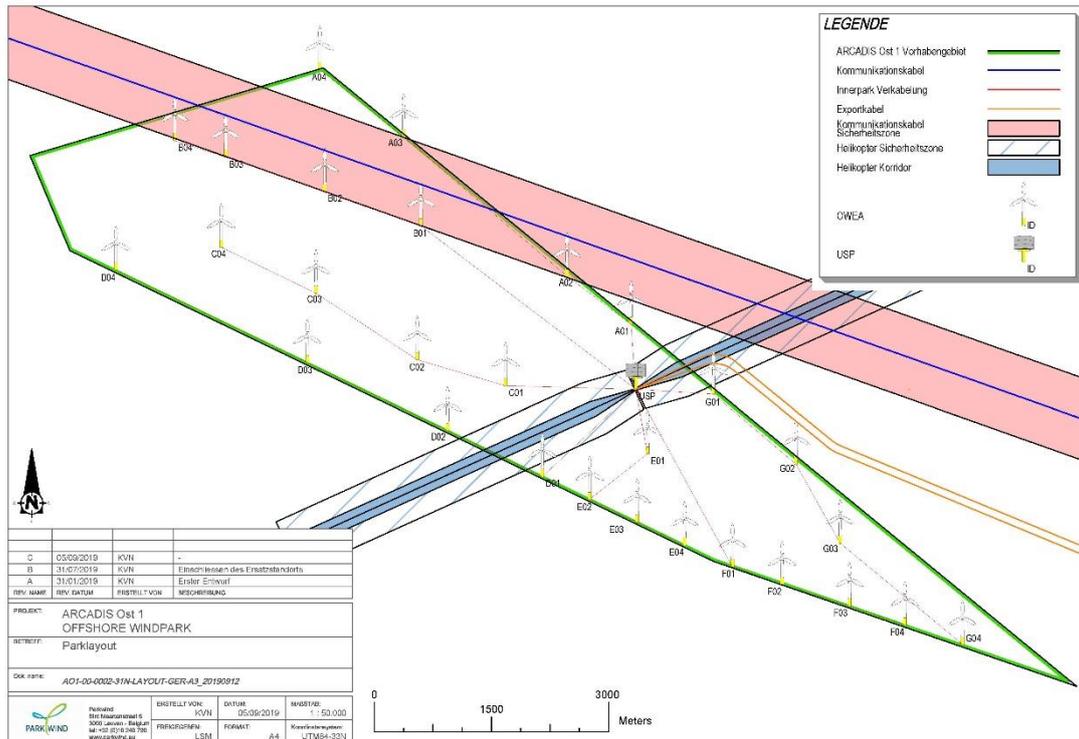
Parklayout mit 28 Anlagen zu je 9,5 MW Leistung (Quelle: Parkwind, 05.09.2019)
